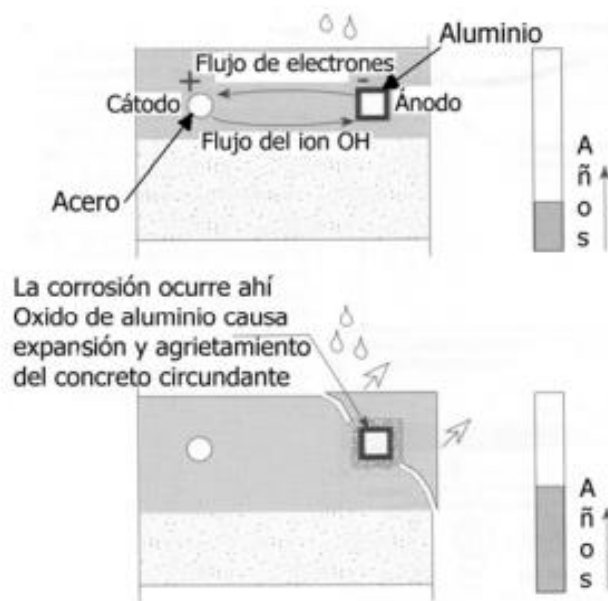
Ejemplo de corrosión galvánica del concreto
